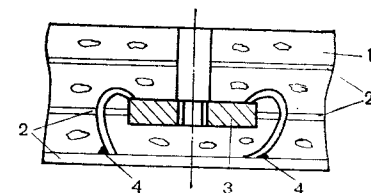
Закладная часть голографического стола для крепления элементов оптической схемы: 1 — бетонная плита; 2 — арматура; 3 — металлический закладной элемент с резьбой; 4 — сварочное соединение
